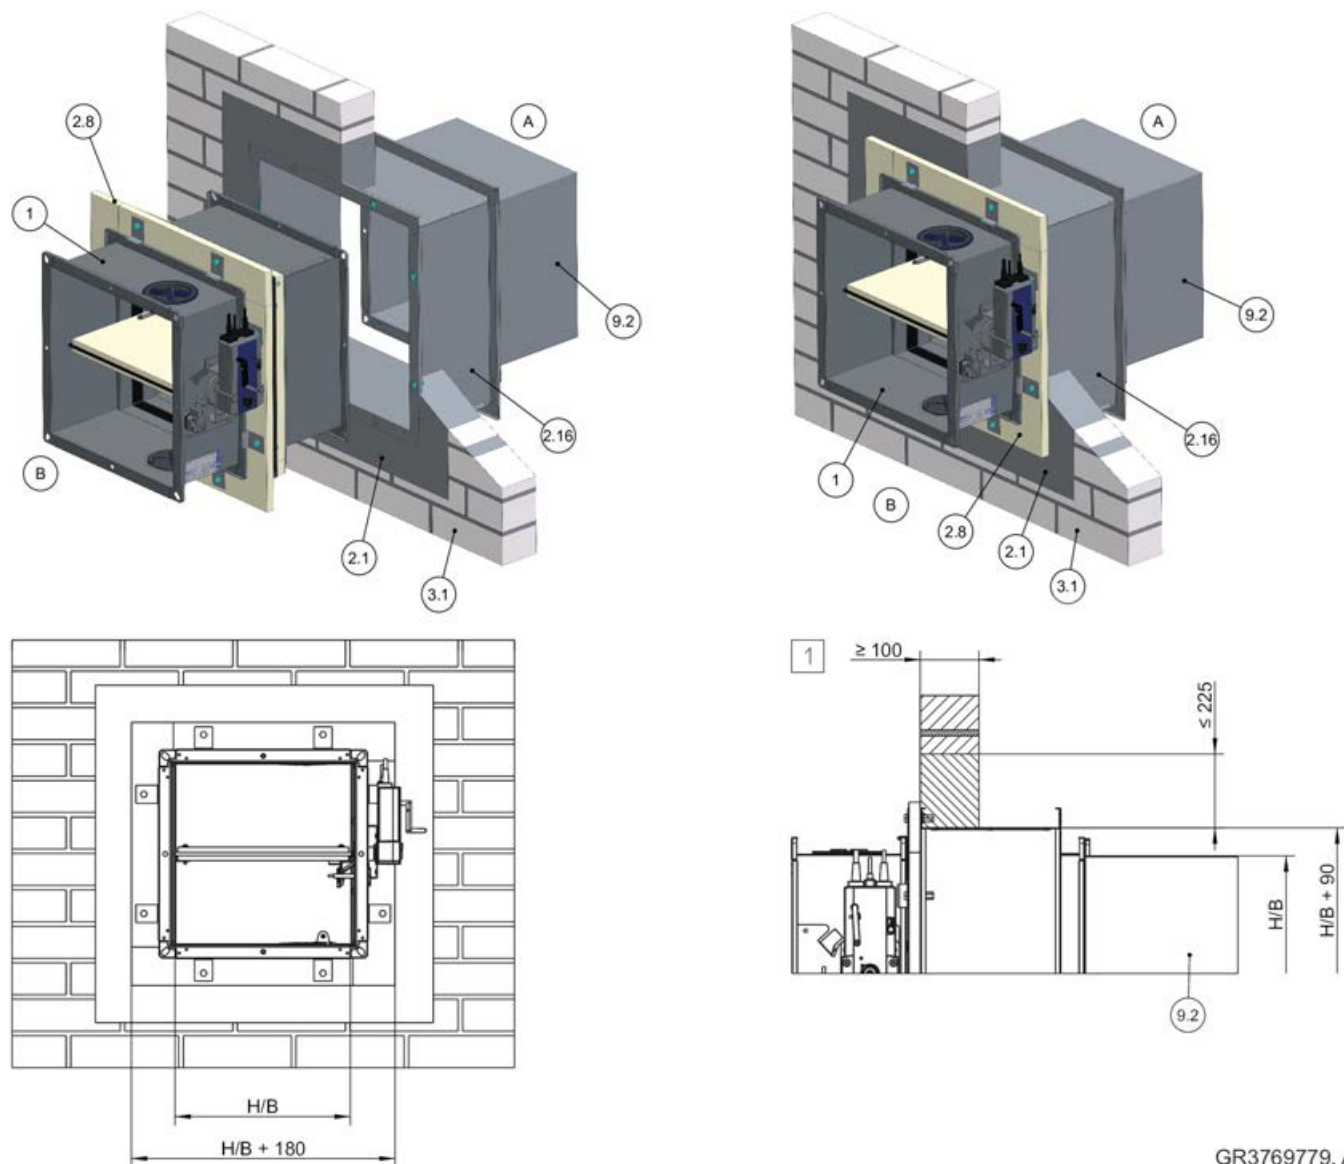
Installazione a secco senza malta in una parete piena, con kit d'installazione EW
